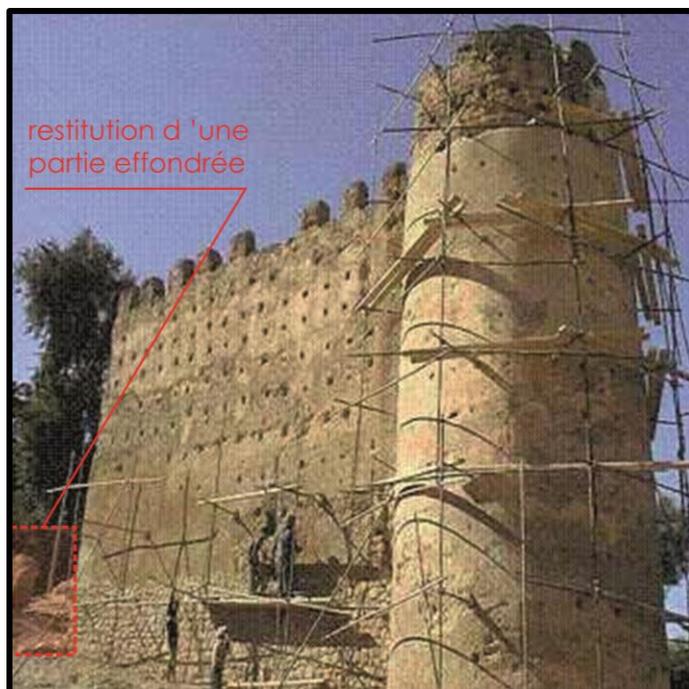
Travaux sur les murs (Source : bureau d'étude ARCAD 03/2003)
